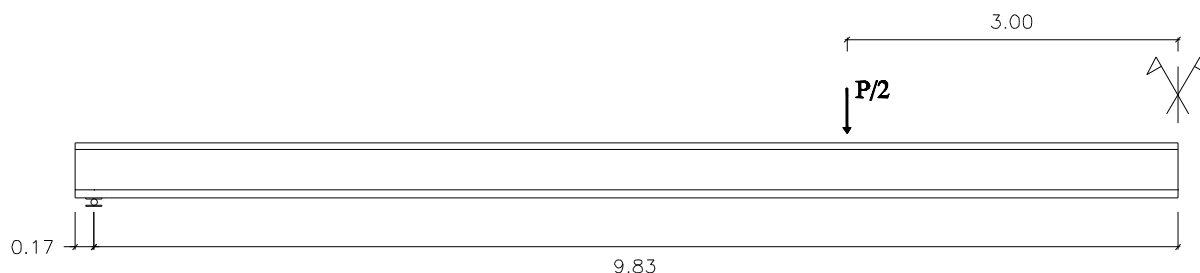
Esquema estrutural do ensaio à rotura da viga reforçada (dimensões em m).
